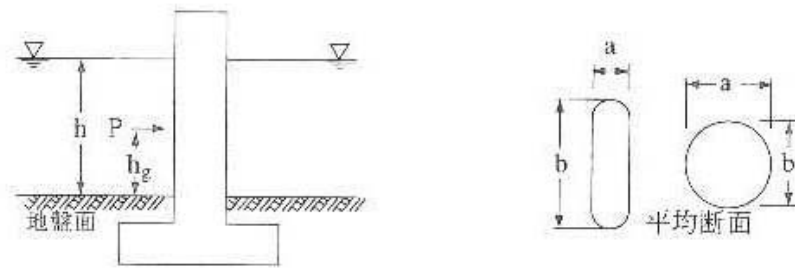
柱状構造物に作用する地震時動水圧
